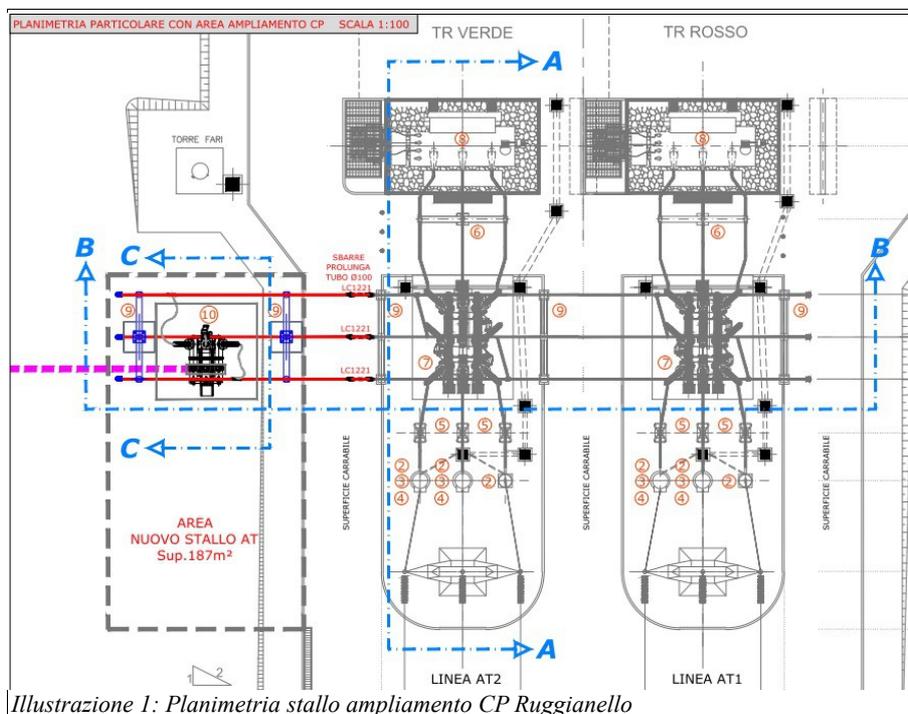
Planimetria stallo ampliamento CP Ruggianello
